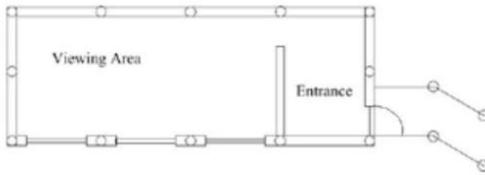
Planta A Con entrada lateral y una dirección de vista
